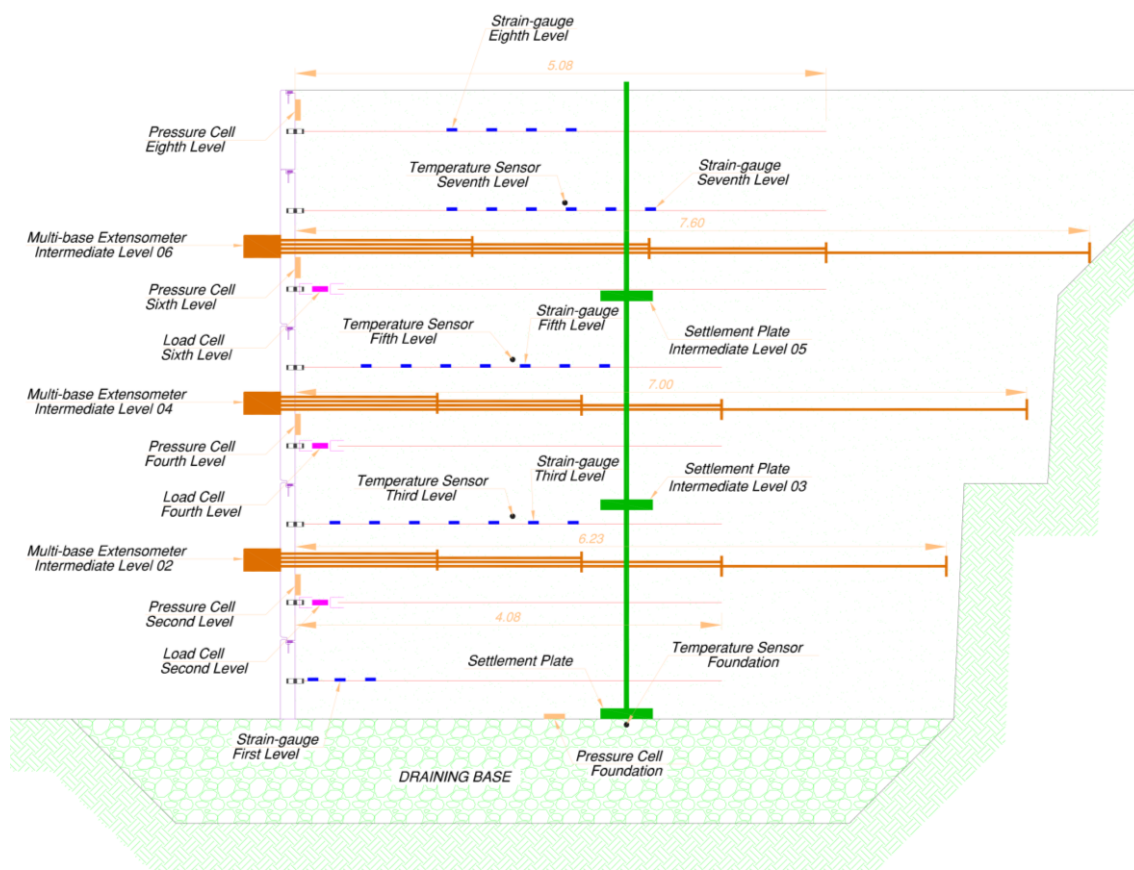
37 – Sezione del muro con i dettagli di posizionamento della strumentazione
